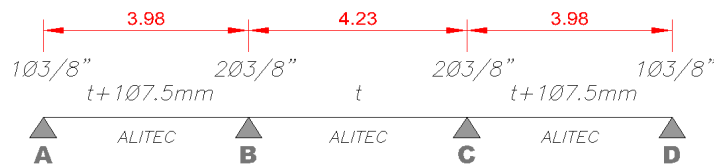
Esquema de las Viguetas Alitec con sus Aceros de Refuerzo.
